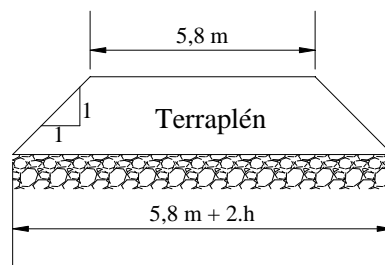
Perfil Tipo para los Tramos N°2 y N°3
